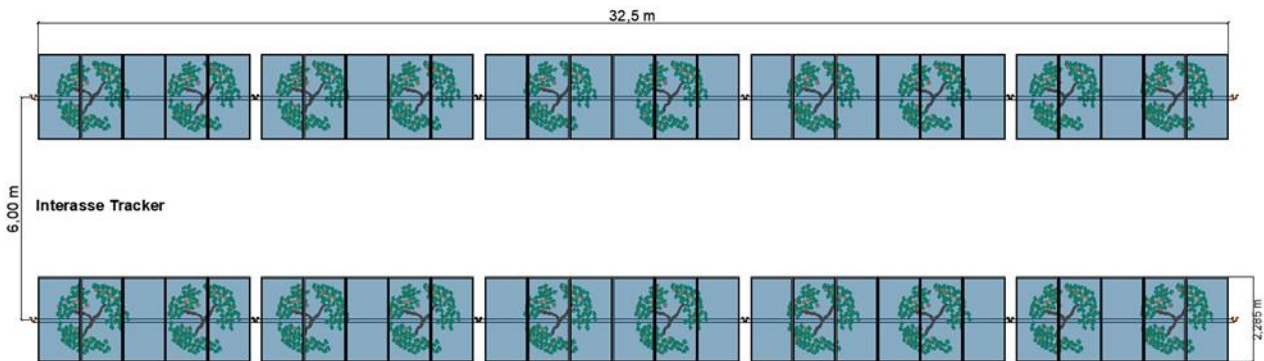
Vista in Pianta delle strutture (c.d. tracker)
